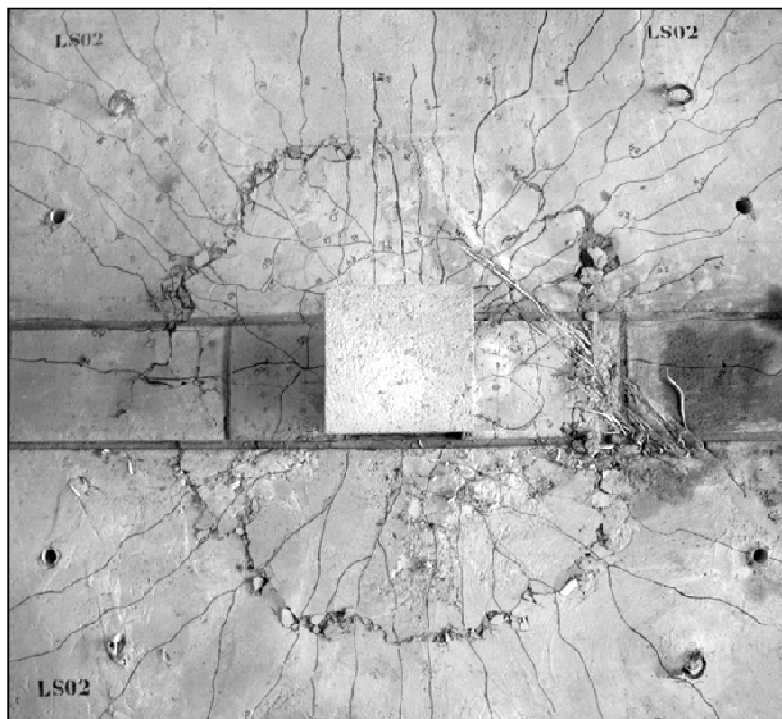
Mapa de fissuração da laje LS02
